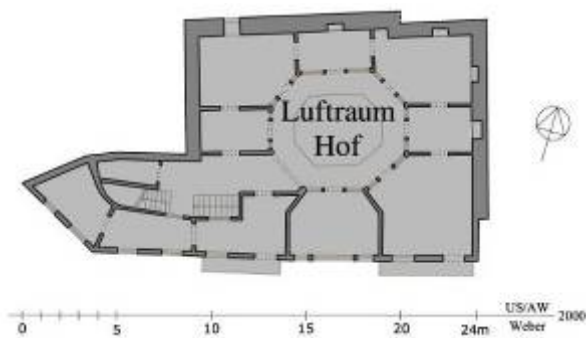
Wakālat al-ʿAššā, Grundriss 1.OG
